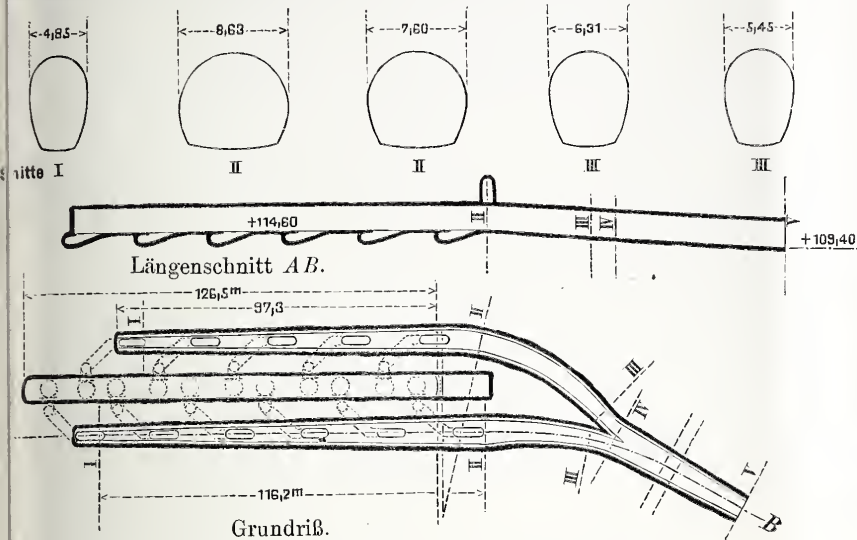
Turbinenkammer mit den Abflußkanälen.
